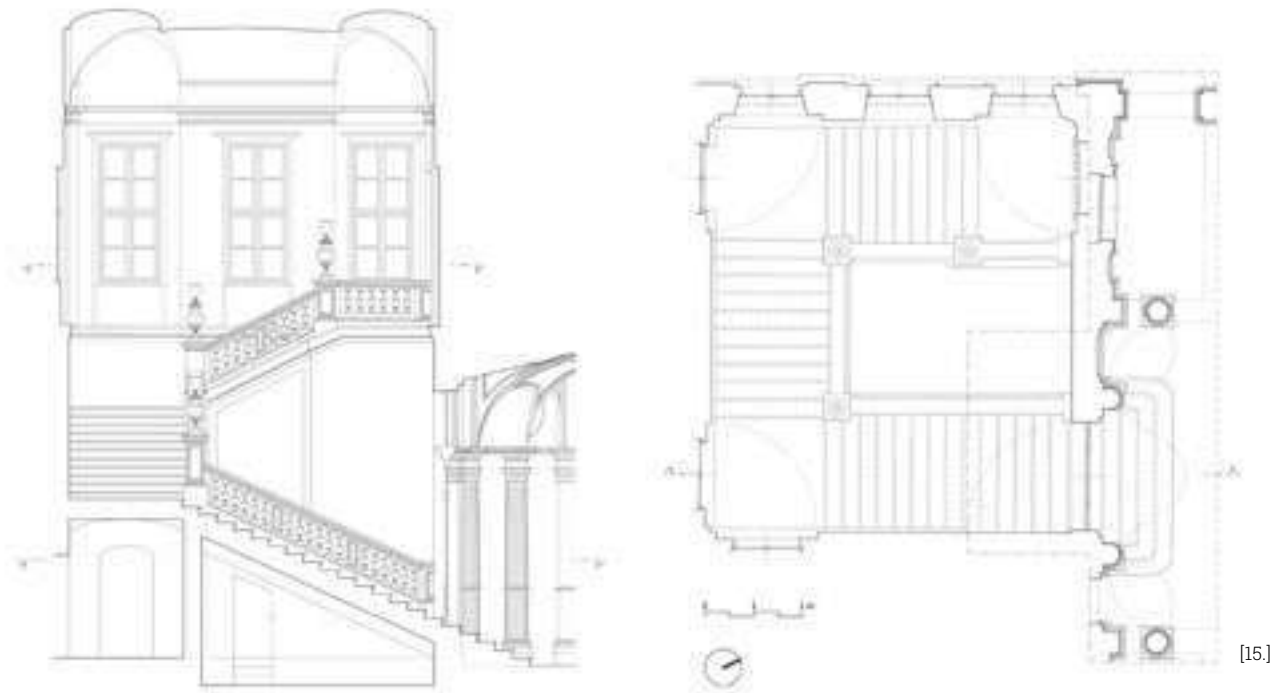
Palazzo Birago di Borgaro*. Sezione trasversale e pianta dello scalone [disegni di Fabrizio Natta].
